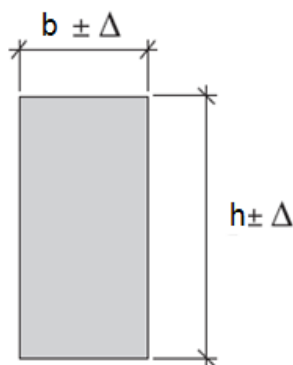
Desvio admissível para as dimensões da secção transversal (adaptado de [15]).
